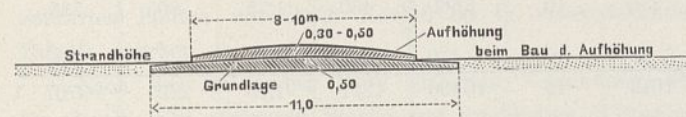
Senklage mit Aufhöhung in Packwerk.
